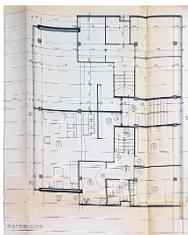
Planta primera dúplex Estructura B-2-4. 1964. Fuente: Archivo Municipal da Coruña
